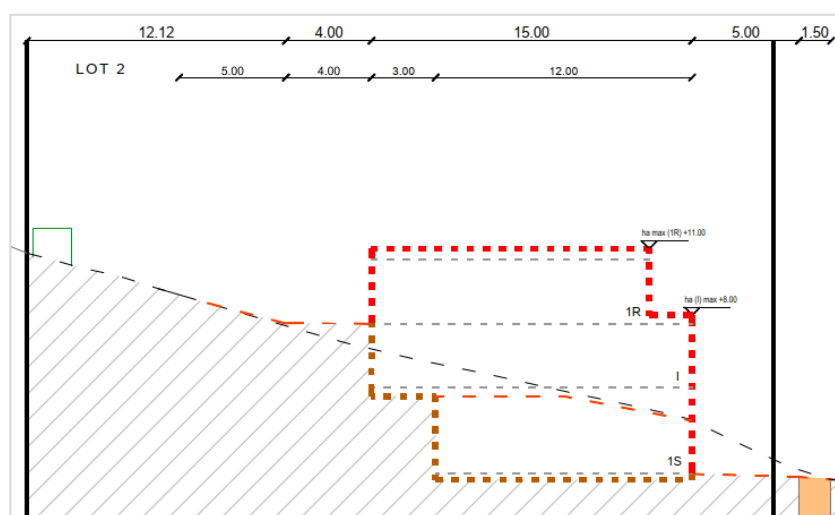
Coupes-Type - aménagement d'un volume secondaire au niveau 1R (Source: BEST)
